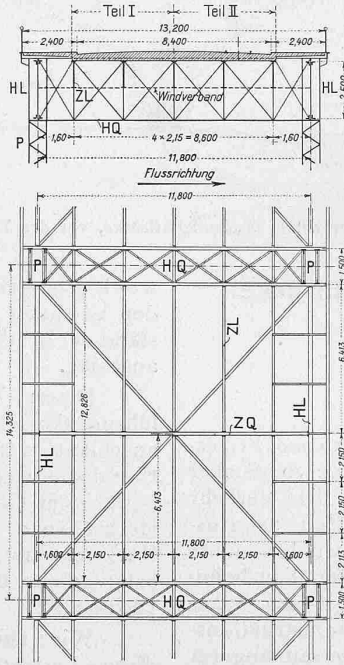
u. 3. Querschnitt und Grundriss eines Fahrbahnfeldes. — 1 : 300.
